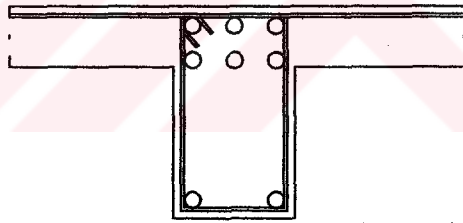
Kirişlerde etriye sıklaştırması ile ilgili ayrıntılar
